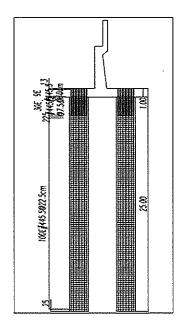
Profundidad y detalle de refuerzo de los pilotes según Diseño Estructural12.
